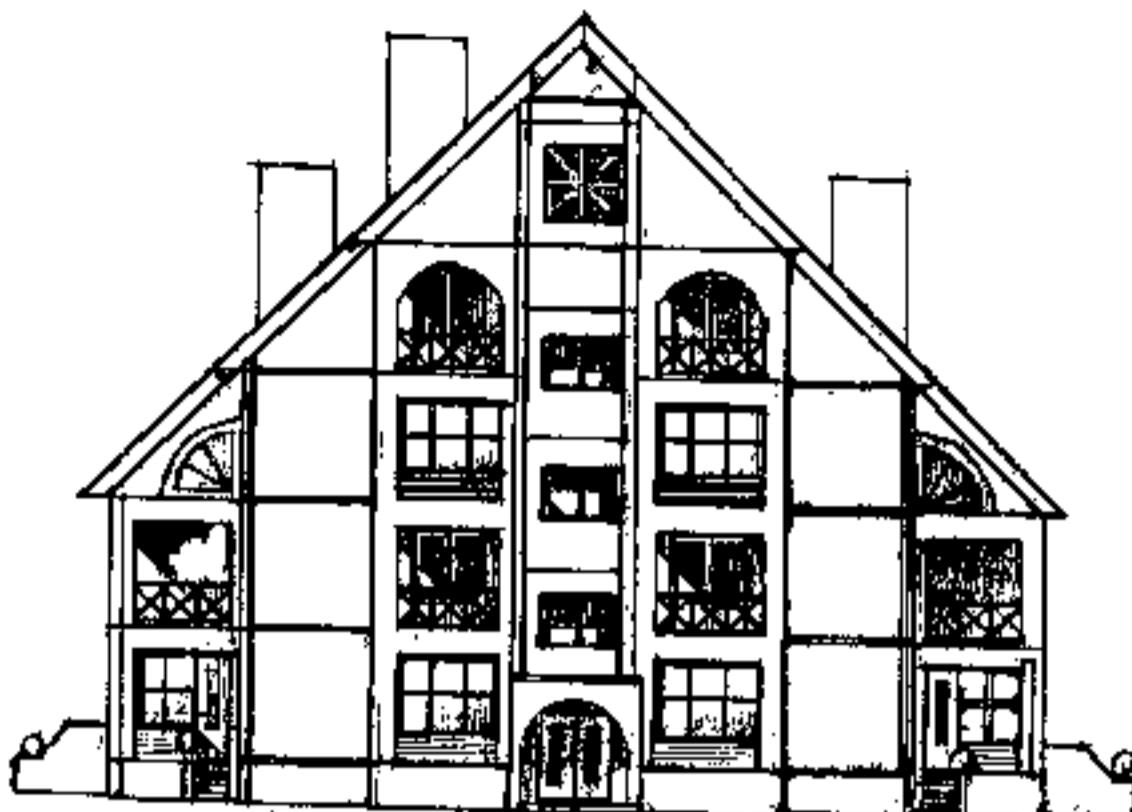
Фасад четырехэтажного 6-квартирного жилого дома с отдельными входами и приусадебными участками
